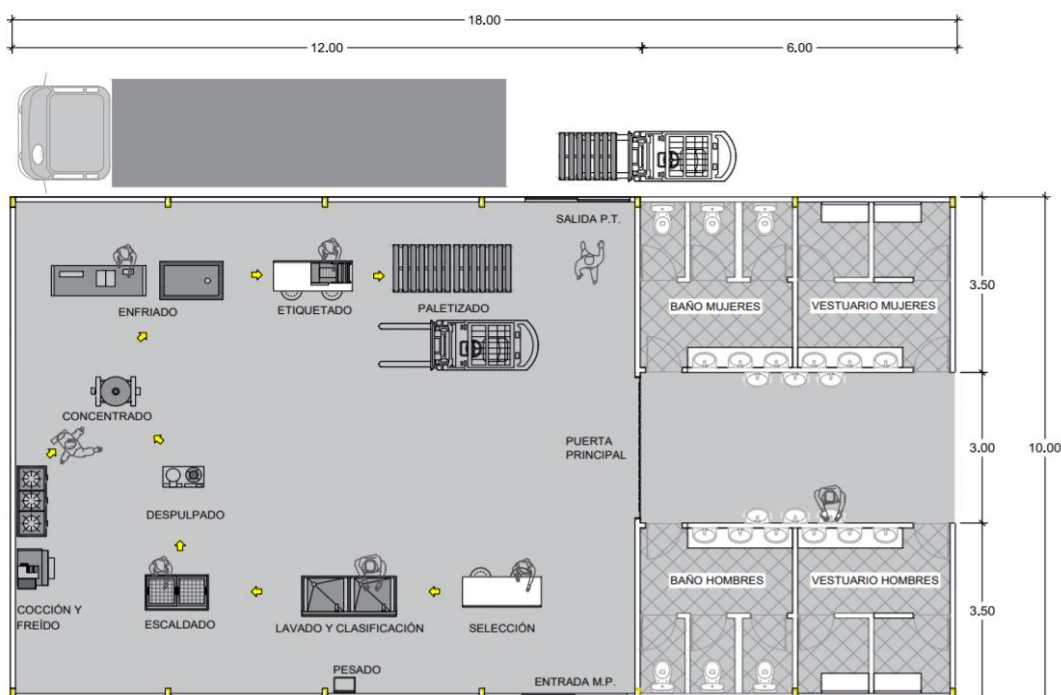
Layout de la planta piloto [Coraizaca & Franco, 2021]
